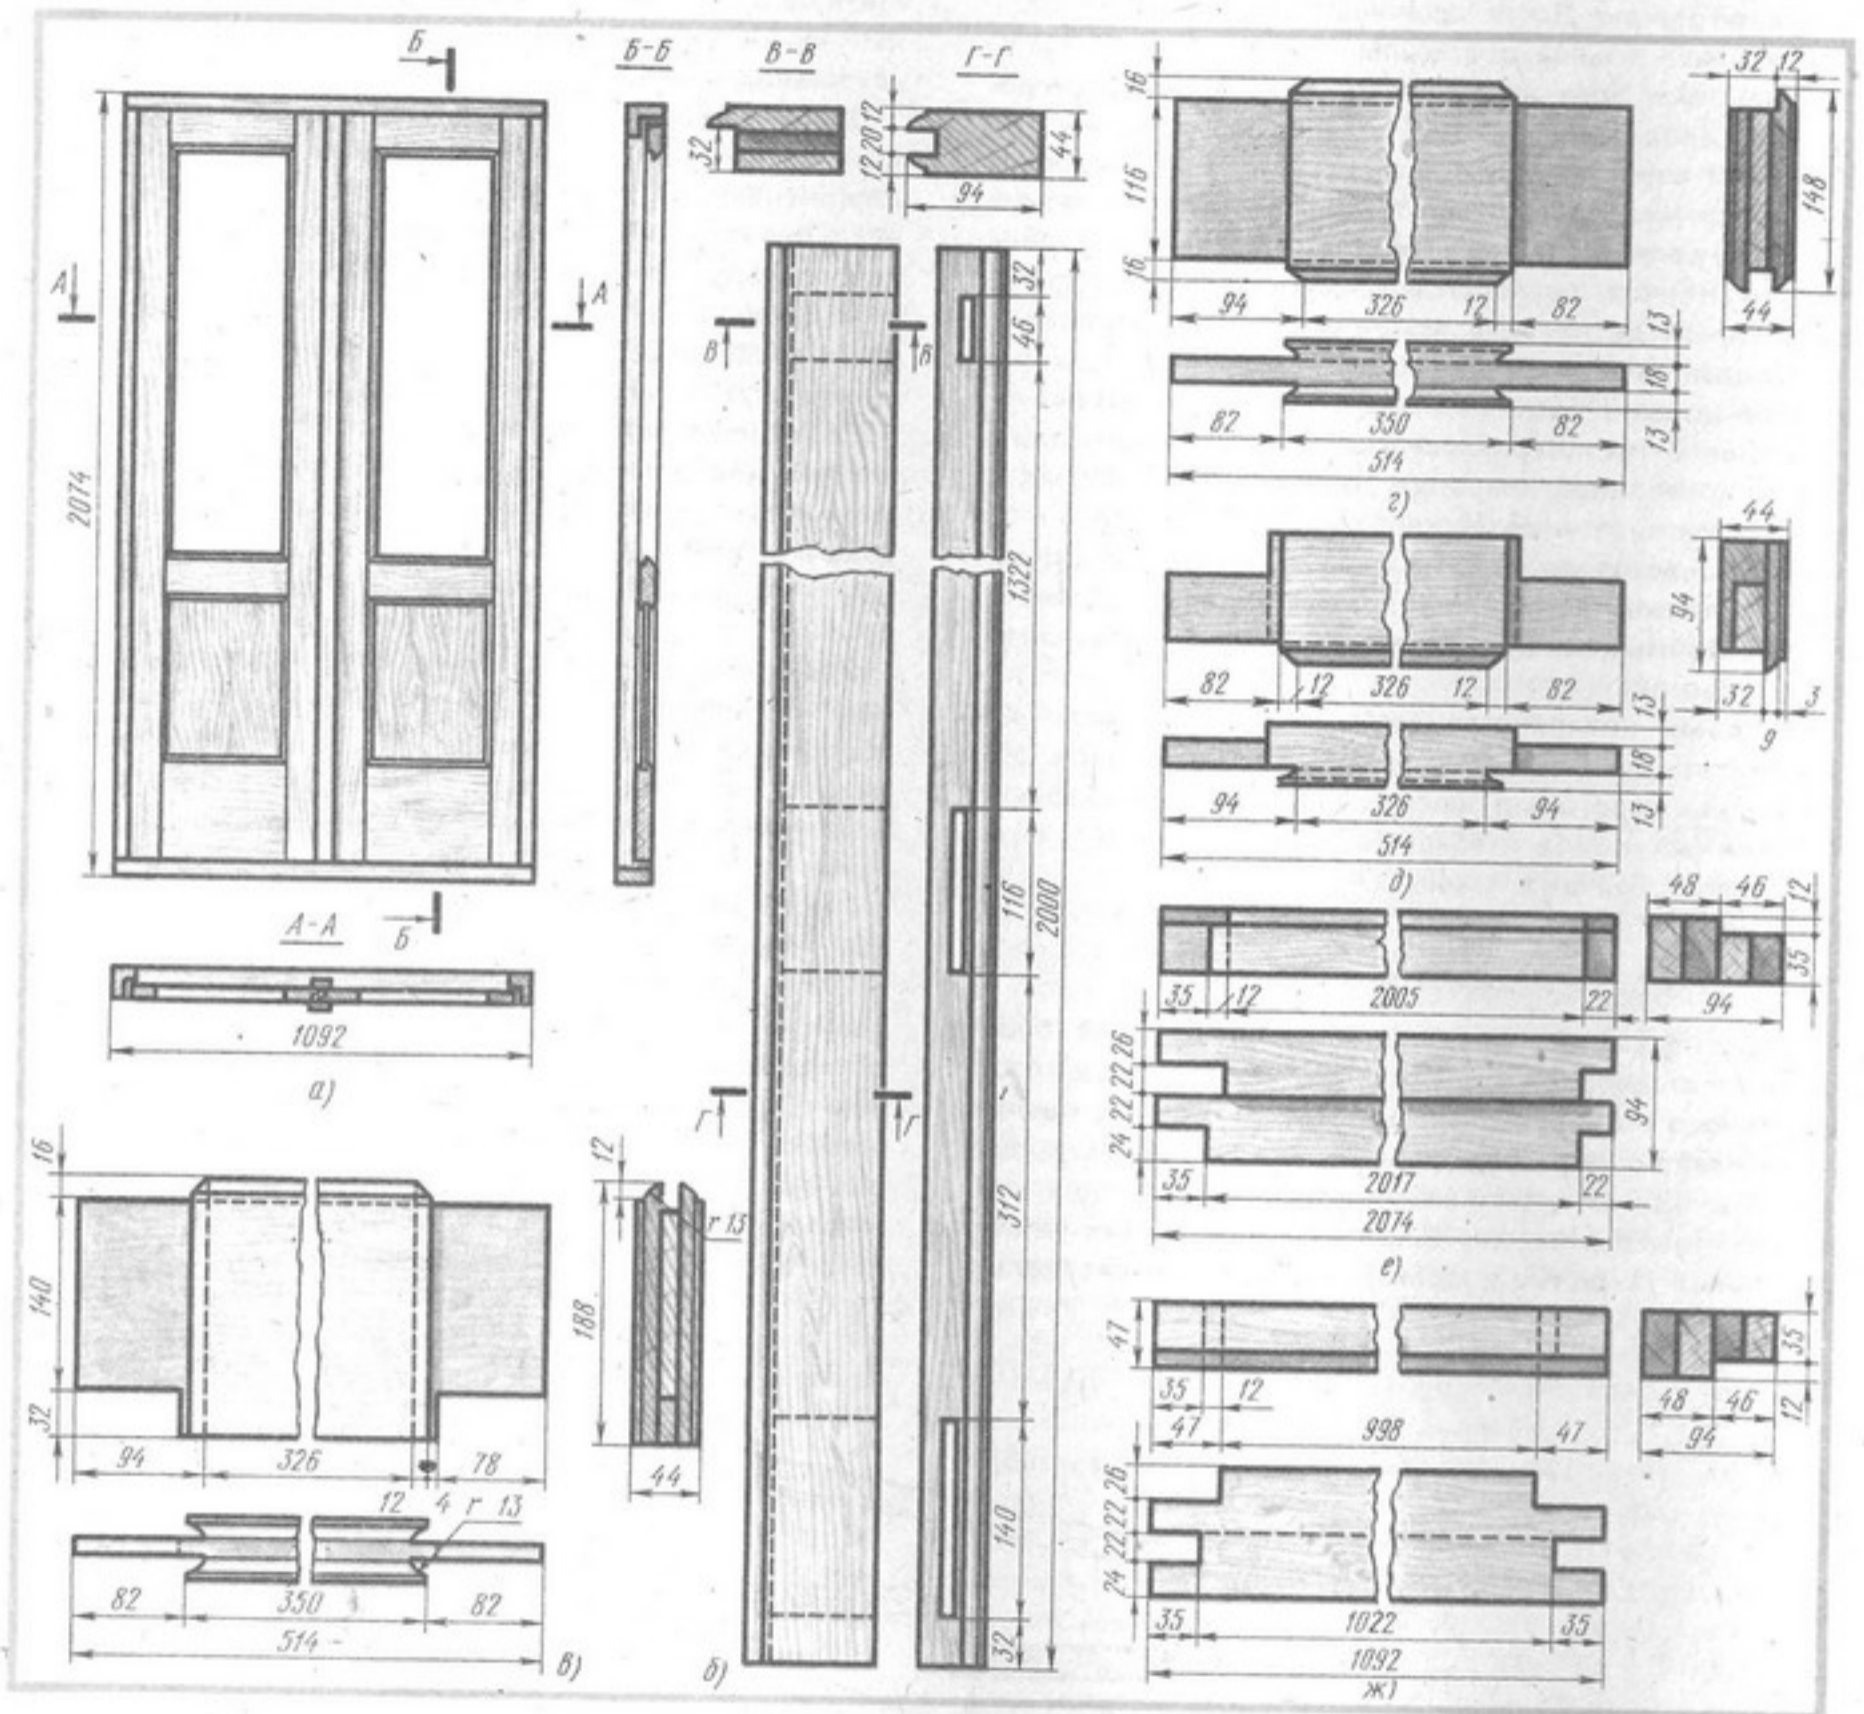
Дверной блок с рамочной (филенчатой) дверью:
